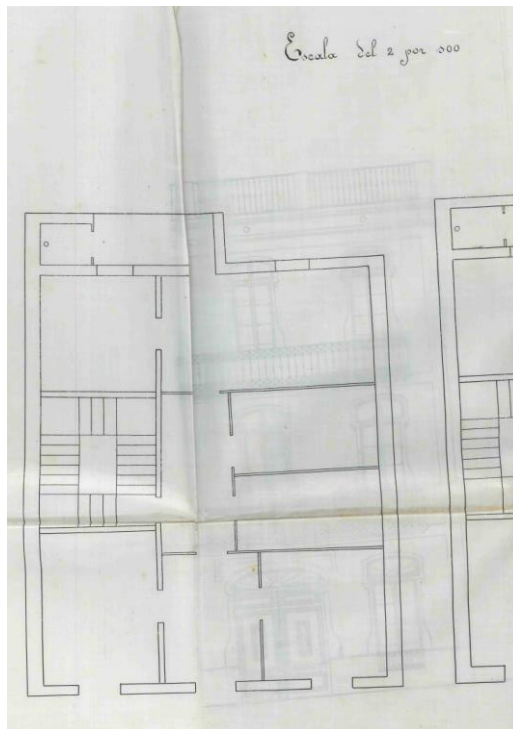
Planos originales archivo municipal de Vilagarcía de Arousa.
